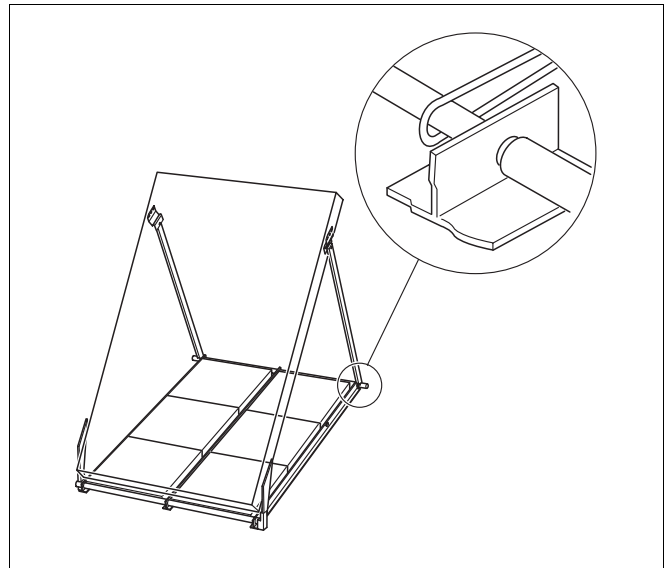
Flachdachständer mit Drahtseilen befestigen
